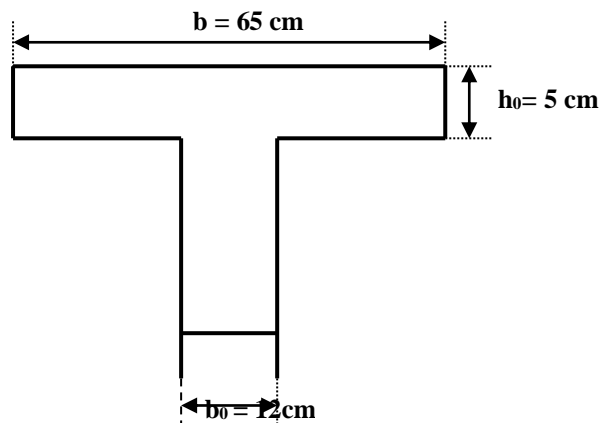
Dimensions des poutrelles du plancher en corps creux
